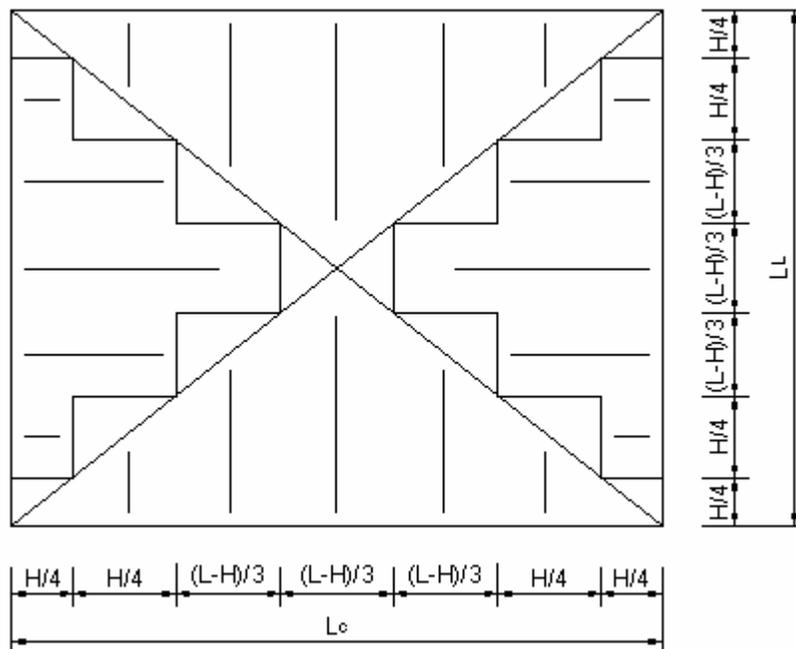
Ubicación de bandas en losa de piso de tanque de concreto reforzado
